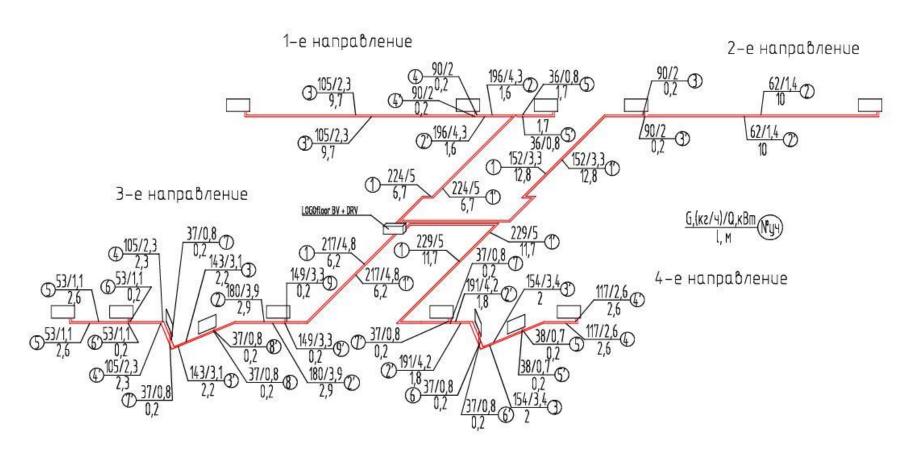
Расчетная схема поквартирной системы отопления (помещений подвала) БС-2
